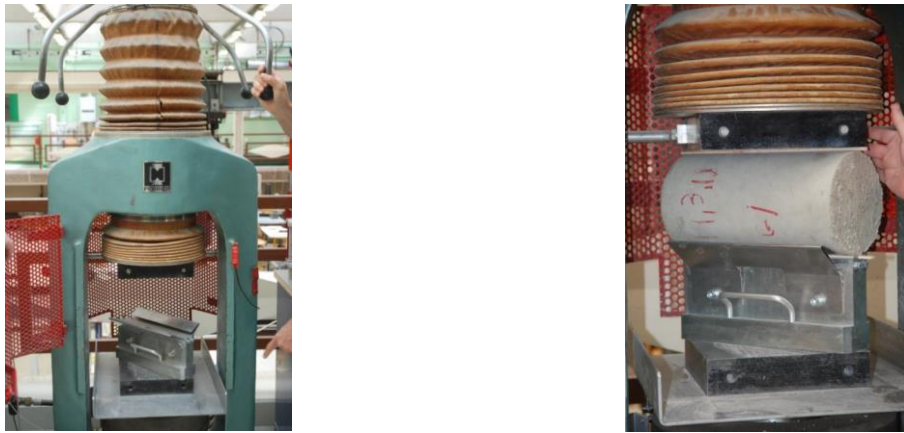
Équipement de la machine pour l'essai de fendage et positionnement de l'éprouvette [40].
